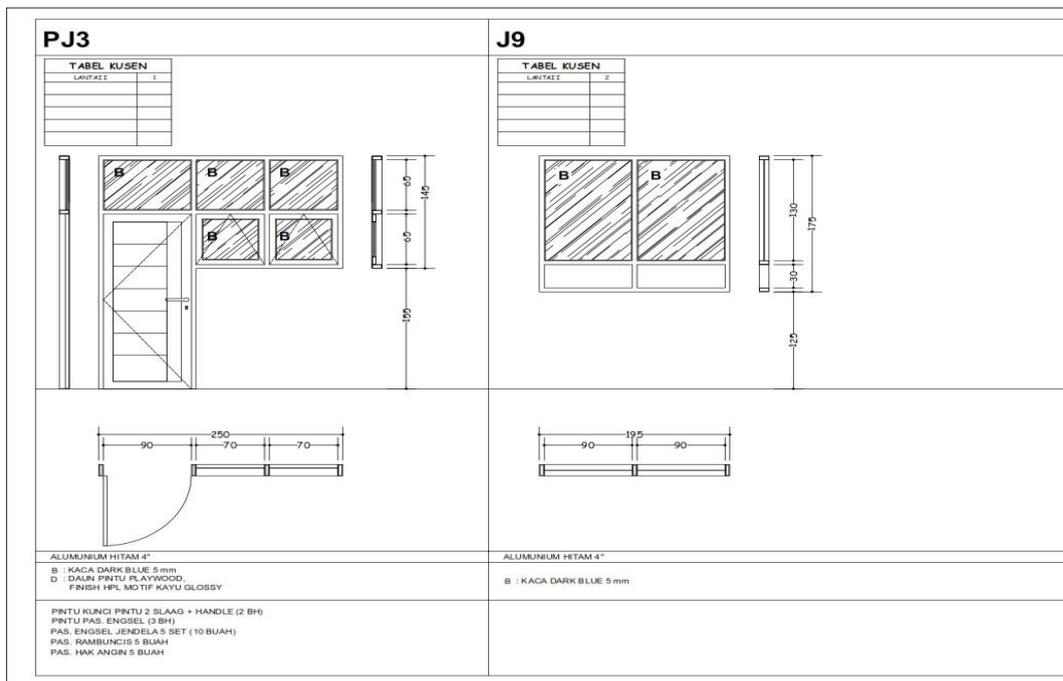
Rencana Kusen Lantai 3
